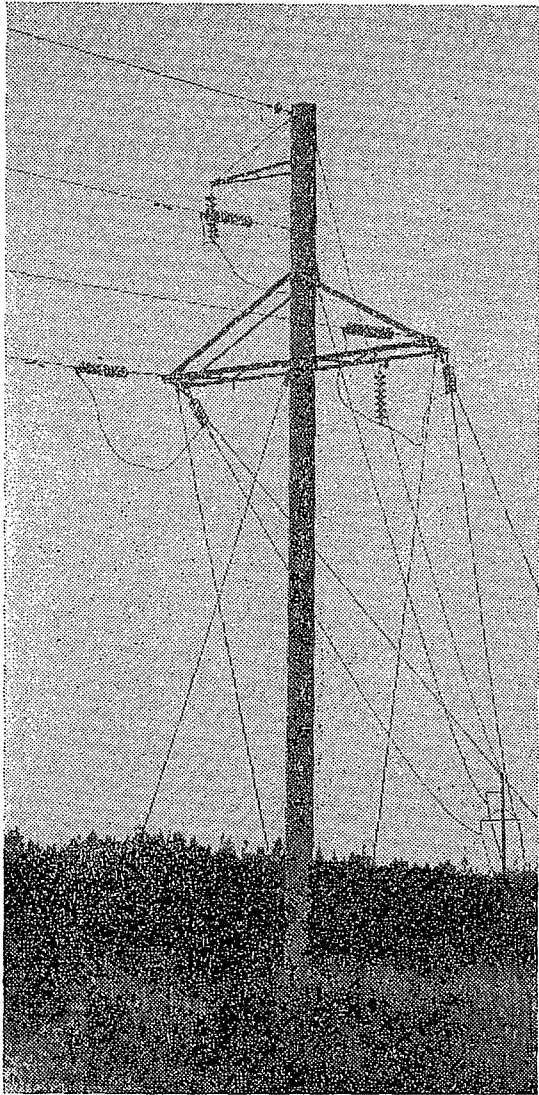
Анкерная угловая железобетонная опора на оттяжках
